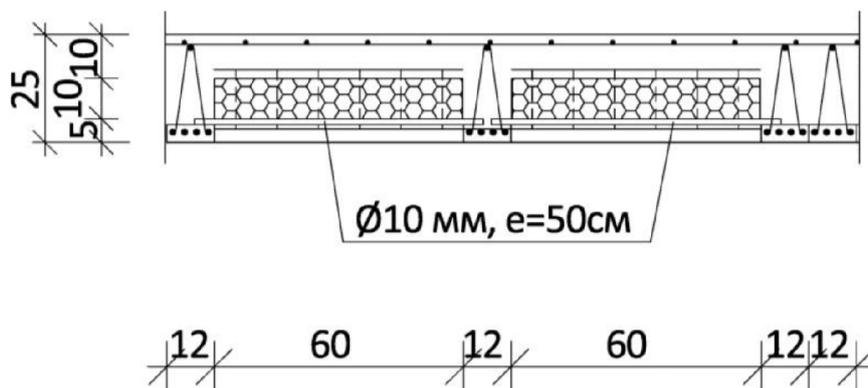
Толстая плита перекрытия с одинарной или двойной решетчатой фермой и трехмерными панелями.
